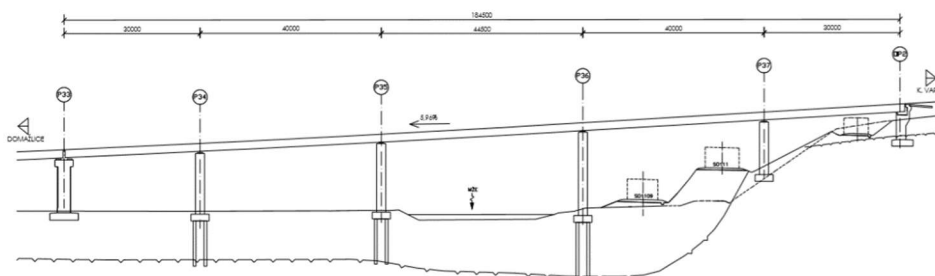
Letmo betonovaná konstrukce – podélný řez
